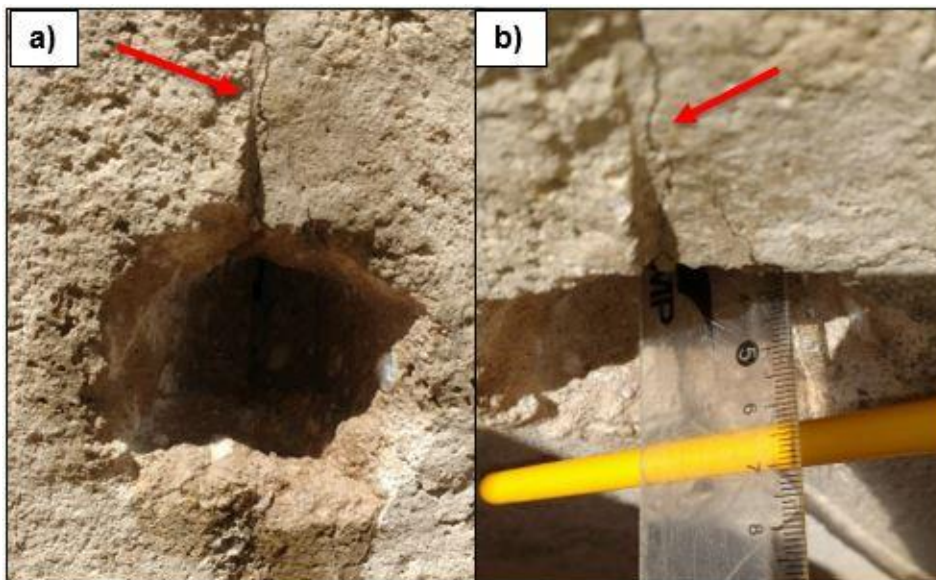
Parede com juntas de concretagem, fissura e perfurações no concreto.
